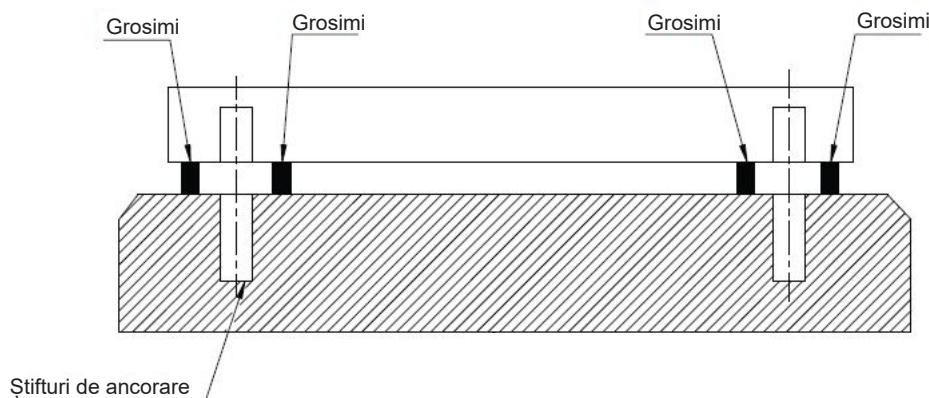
Aplicarea fundațiilor din beton, a lamei și a ancorajului
